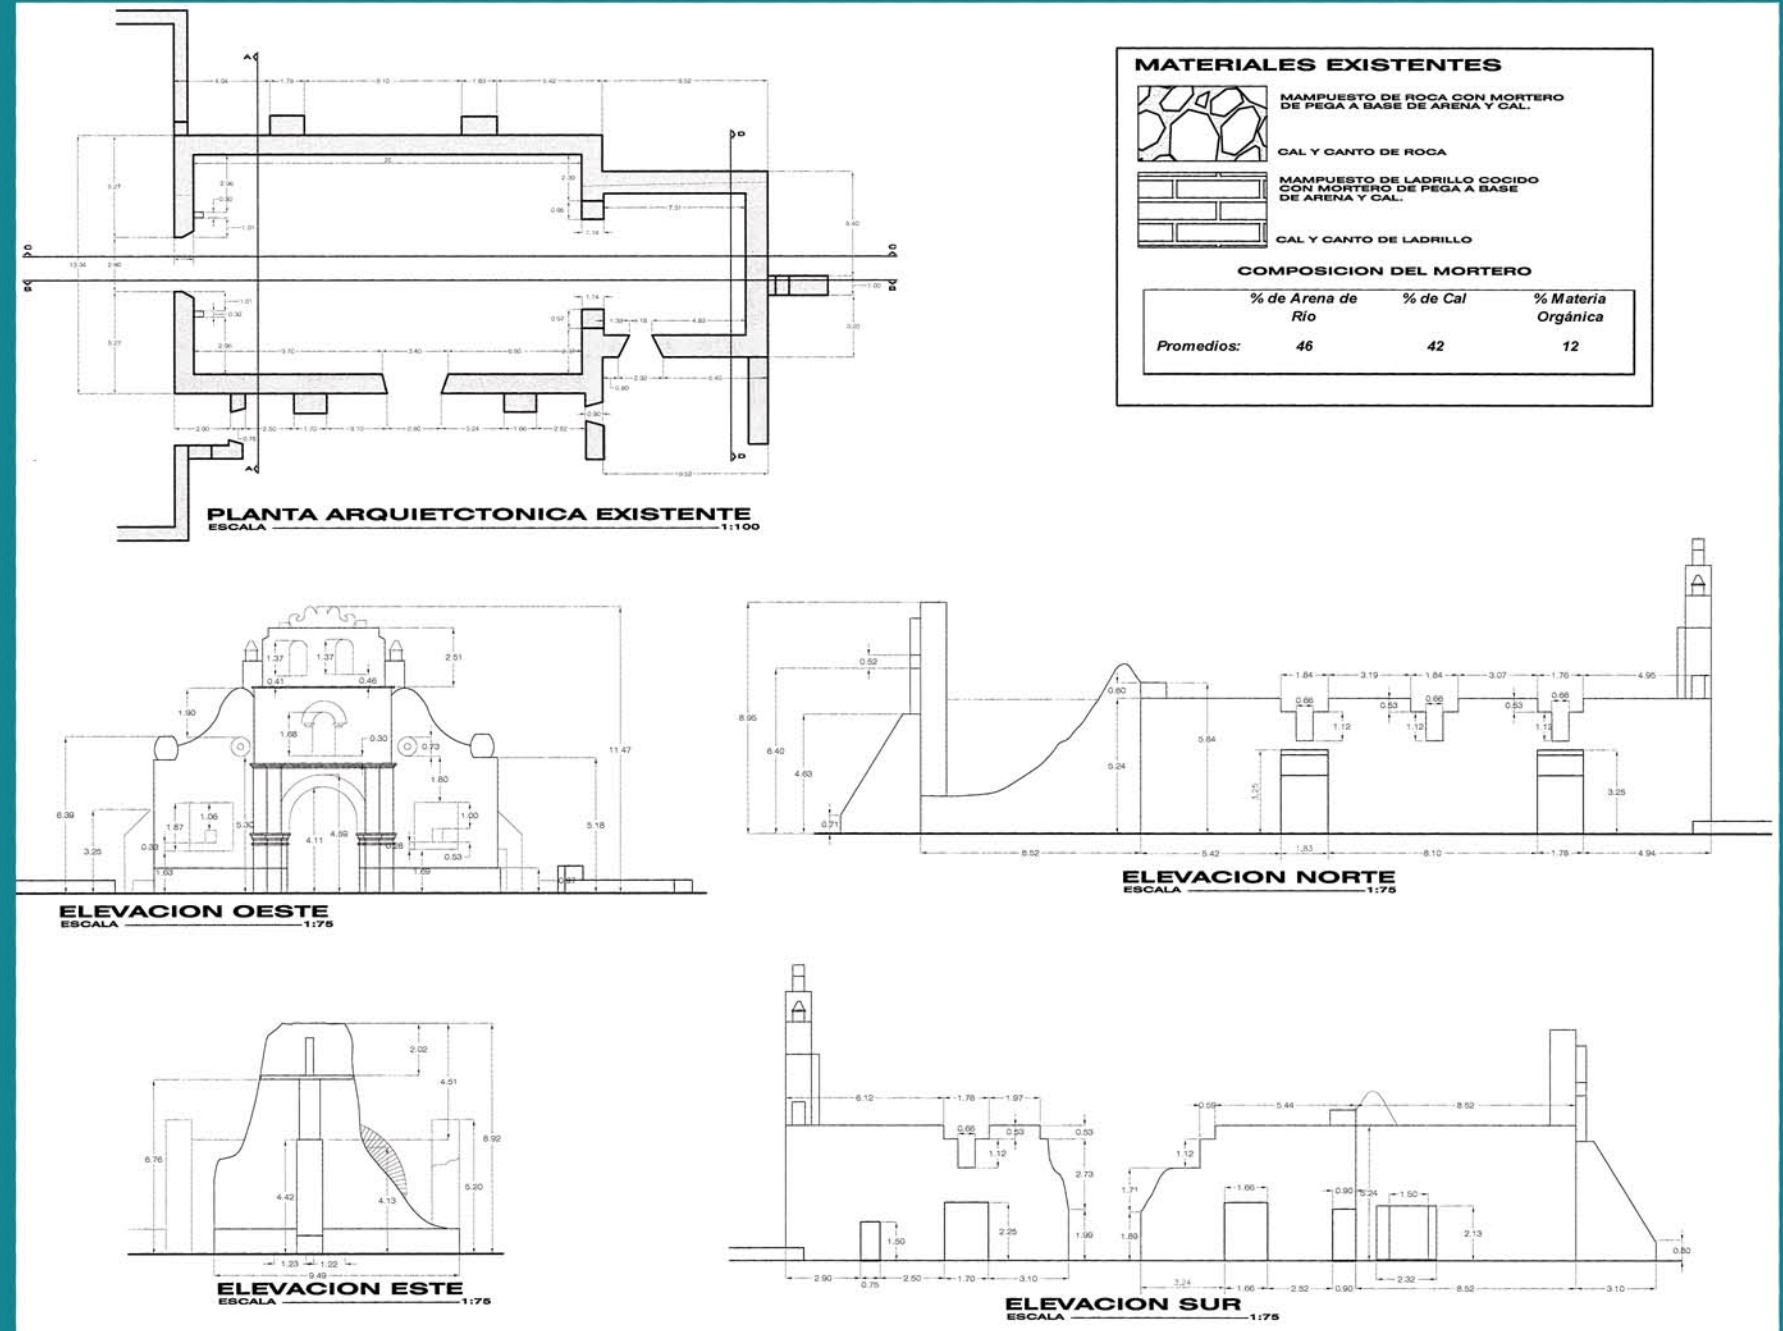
Planta Arq. y Elevaciones Ruinas de Ujarrás
